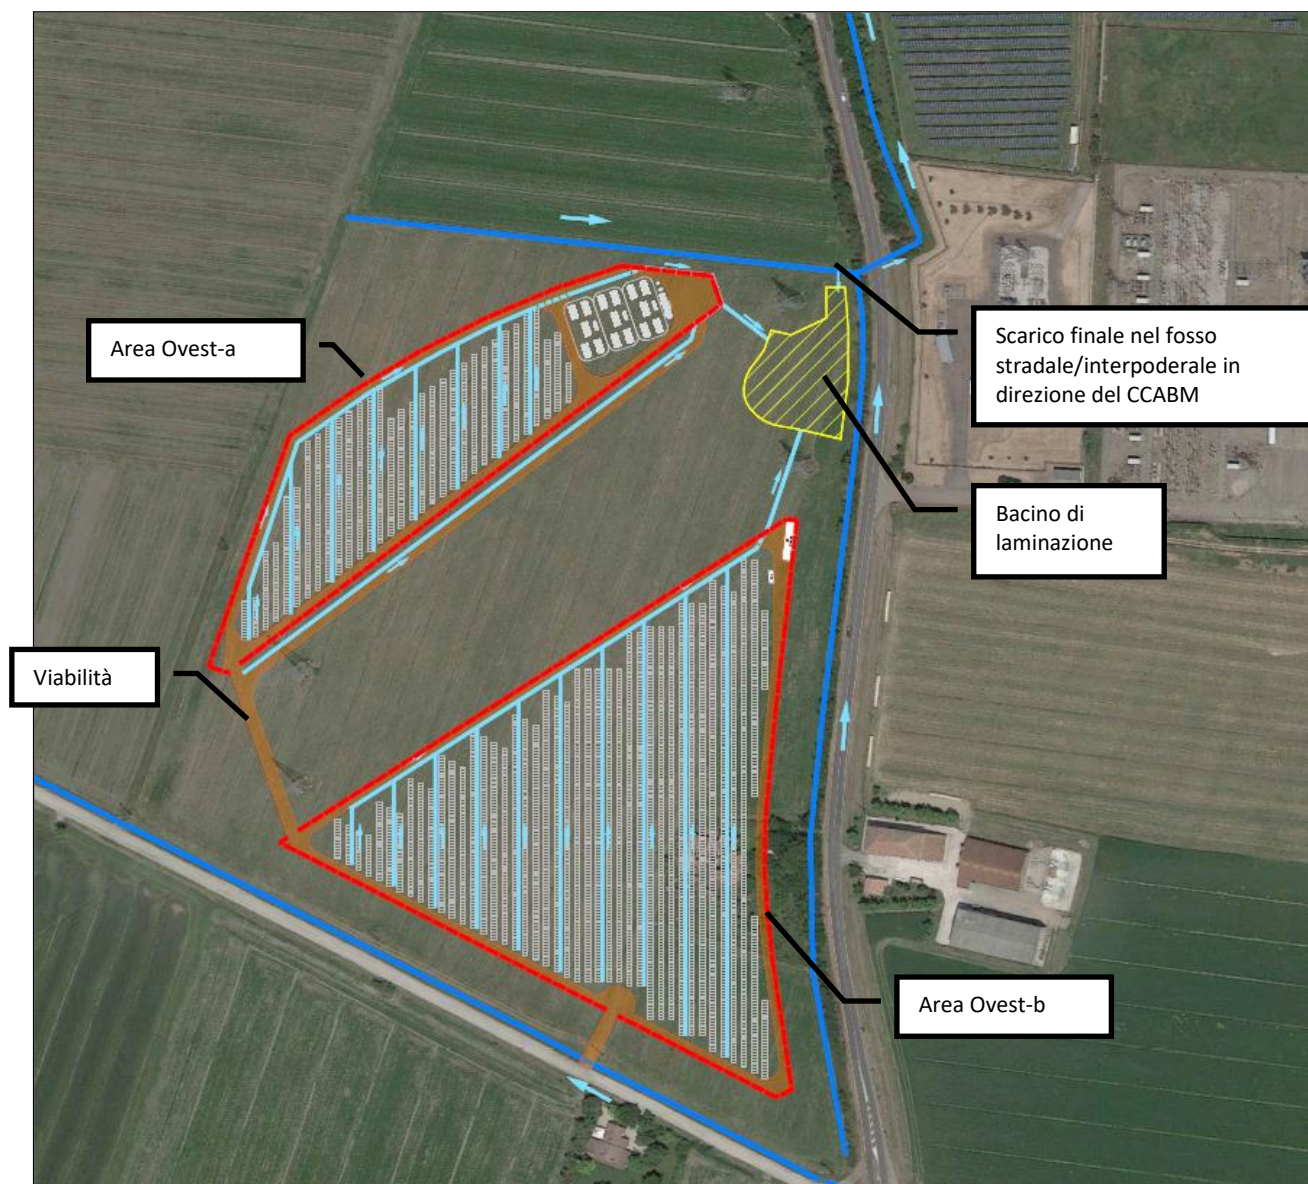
Schema della rete di drenaggio in progetto (Area Ovest).
